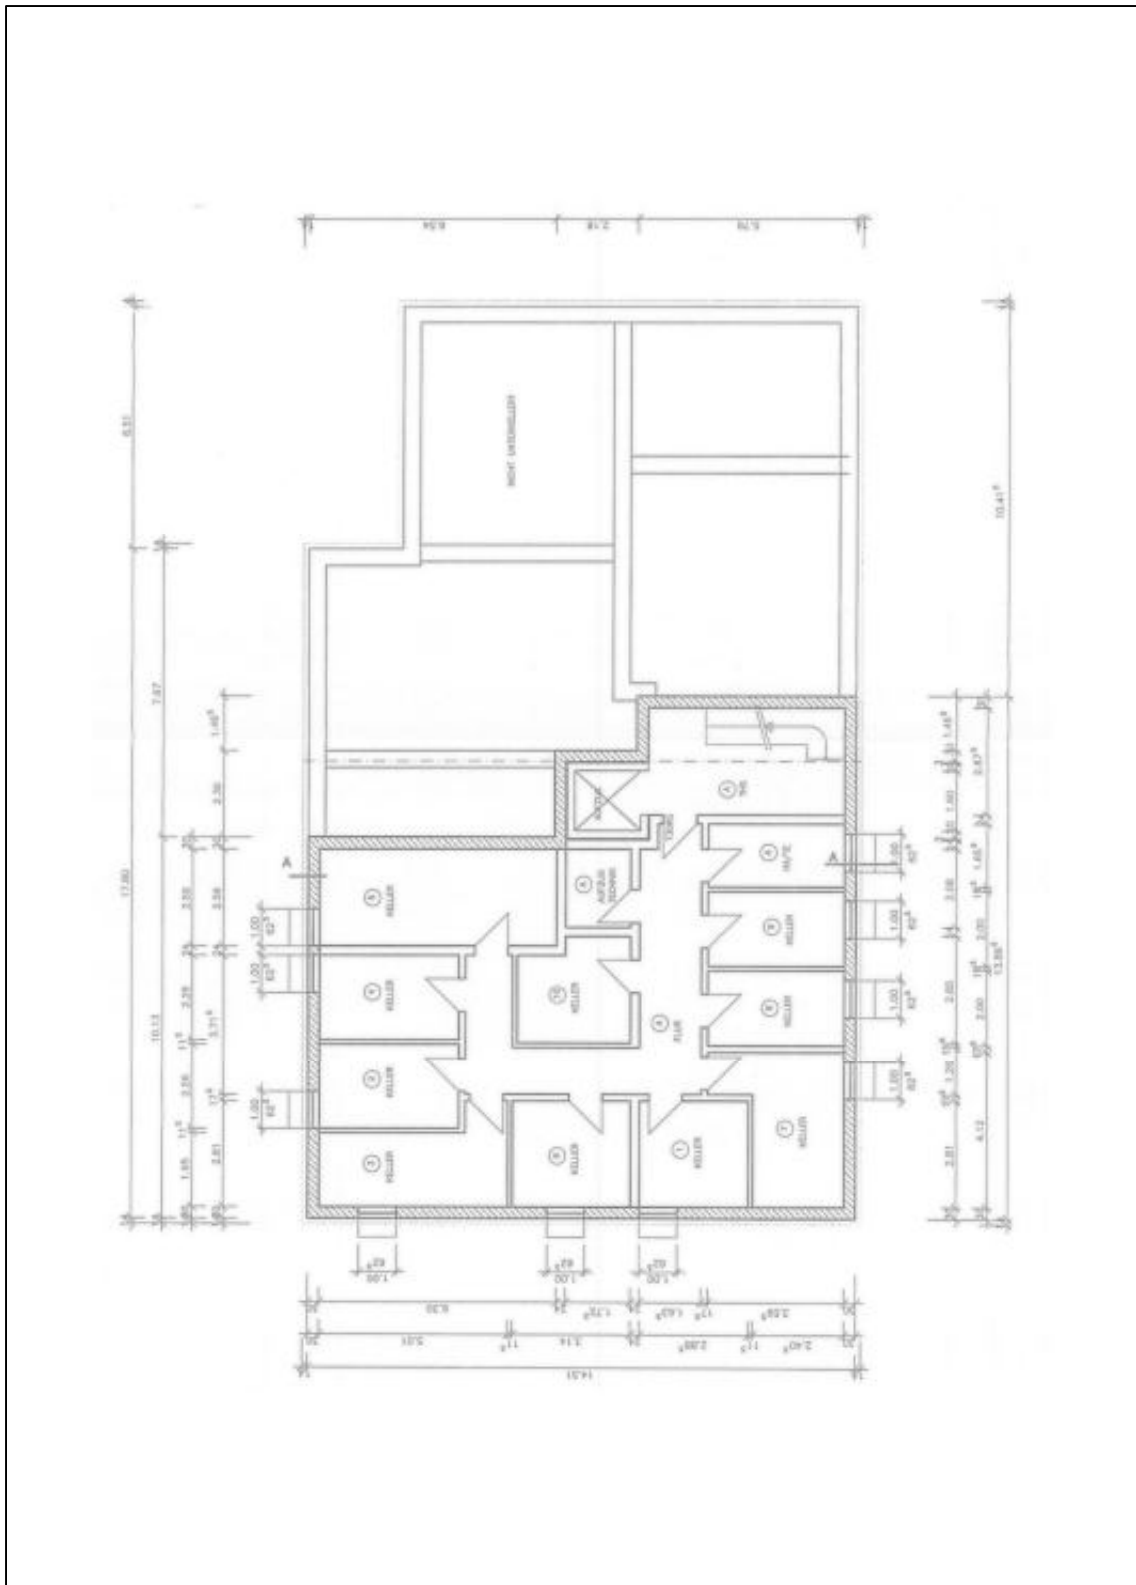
Grundriss vom Kellergeschoss
